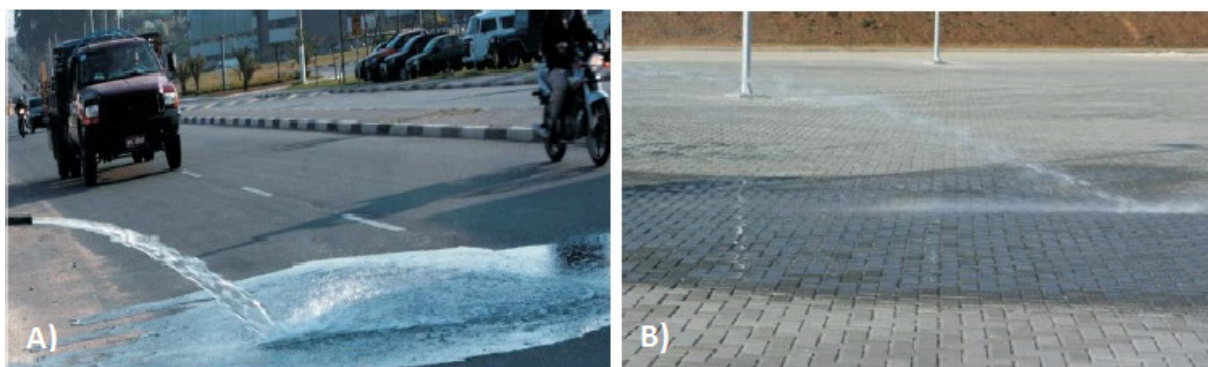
Pavimento impermeável (a) x Pavimento permeável (b)
